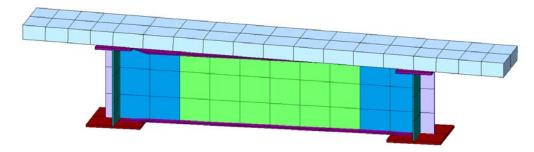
Sovrappasso di uscita - diaframma pieno di pila
